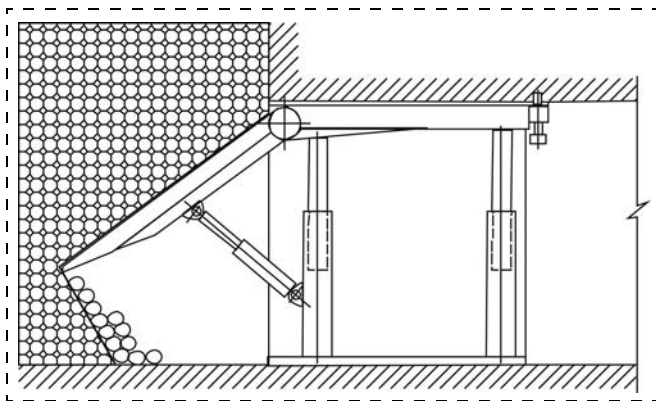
Пассивные, перемещающиеся за фронтом выпуска, огражденные крепи, изготовленные из металла
